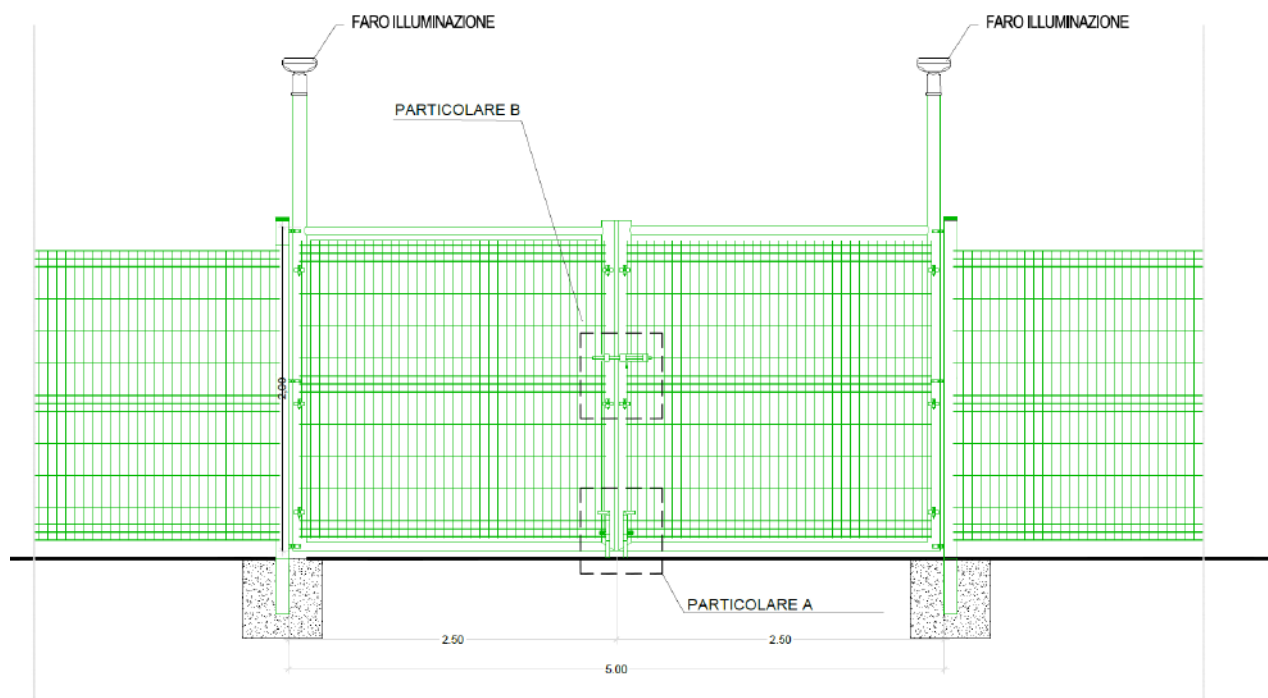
Tipologico cancello di accesso alle aree di impianto.
